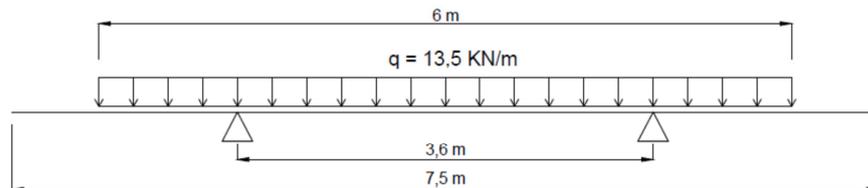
Viga teórica para el cálculo de las vigas transversales apoyadas sobre los pilotes. Cortante máximo
